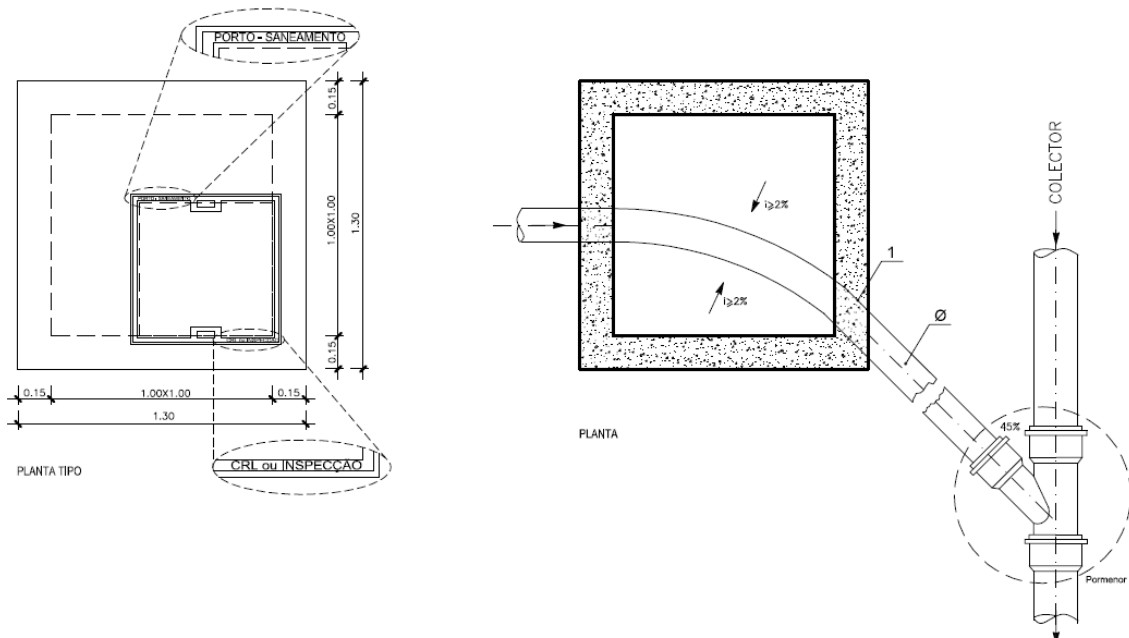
Câmara ramal de ligação – Planta tipo.
